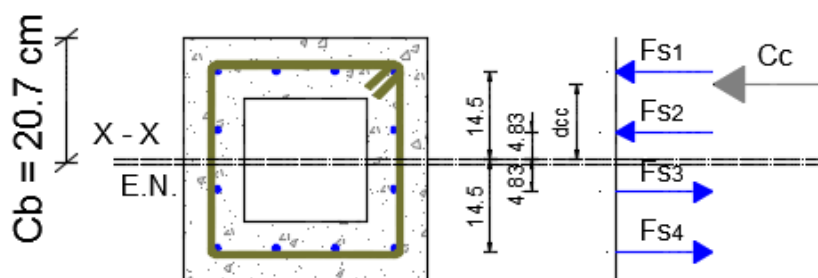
Esquema general de deformaciones, esfuerzos y fuerzas en la sección transversal cuadrada
